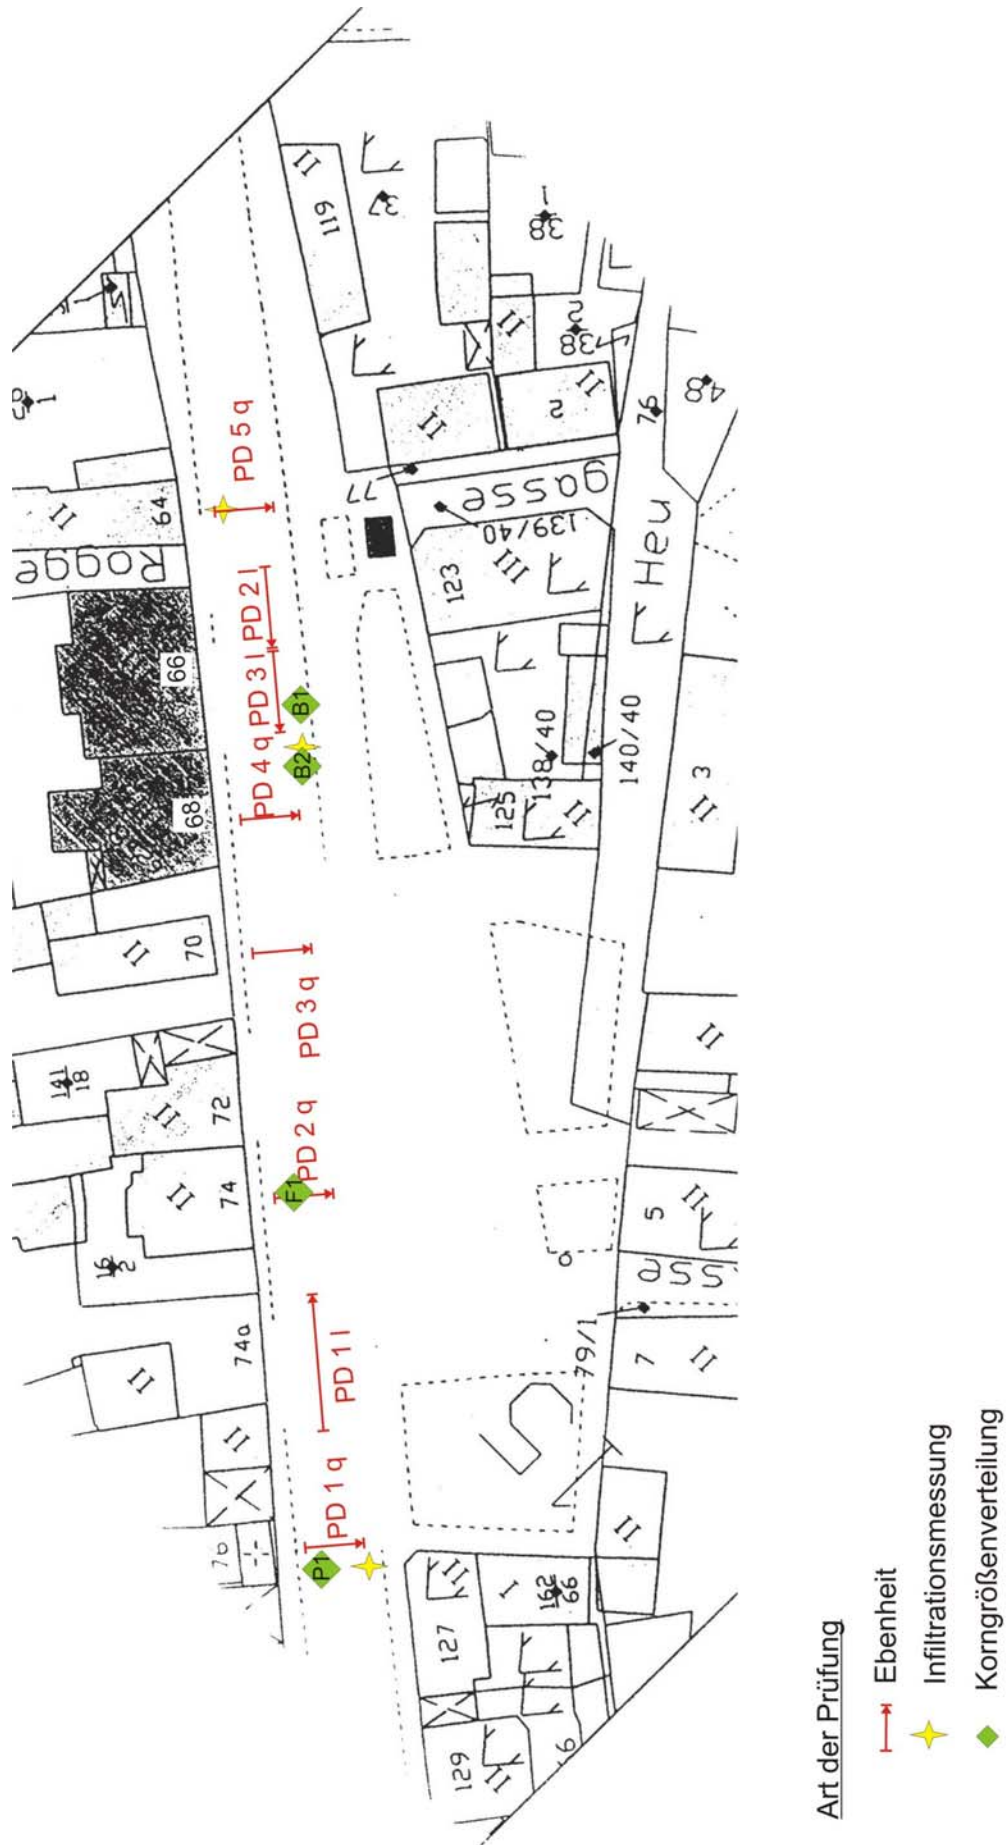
Lageplan Liederbacher Straße: Messstellen auf der Pflasterdecke
